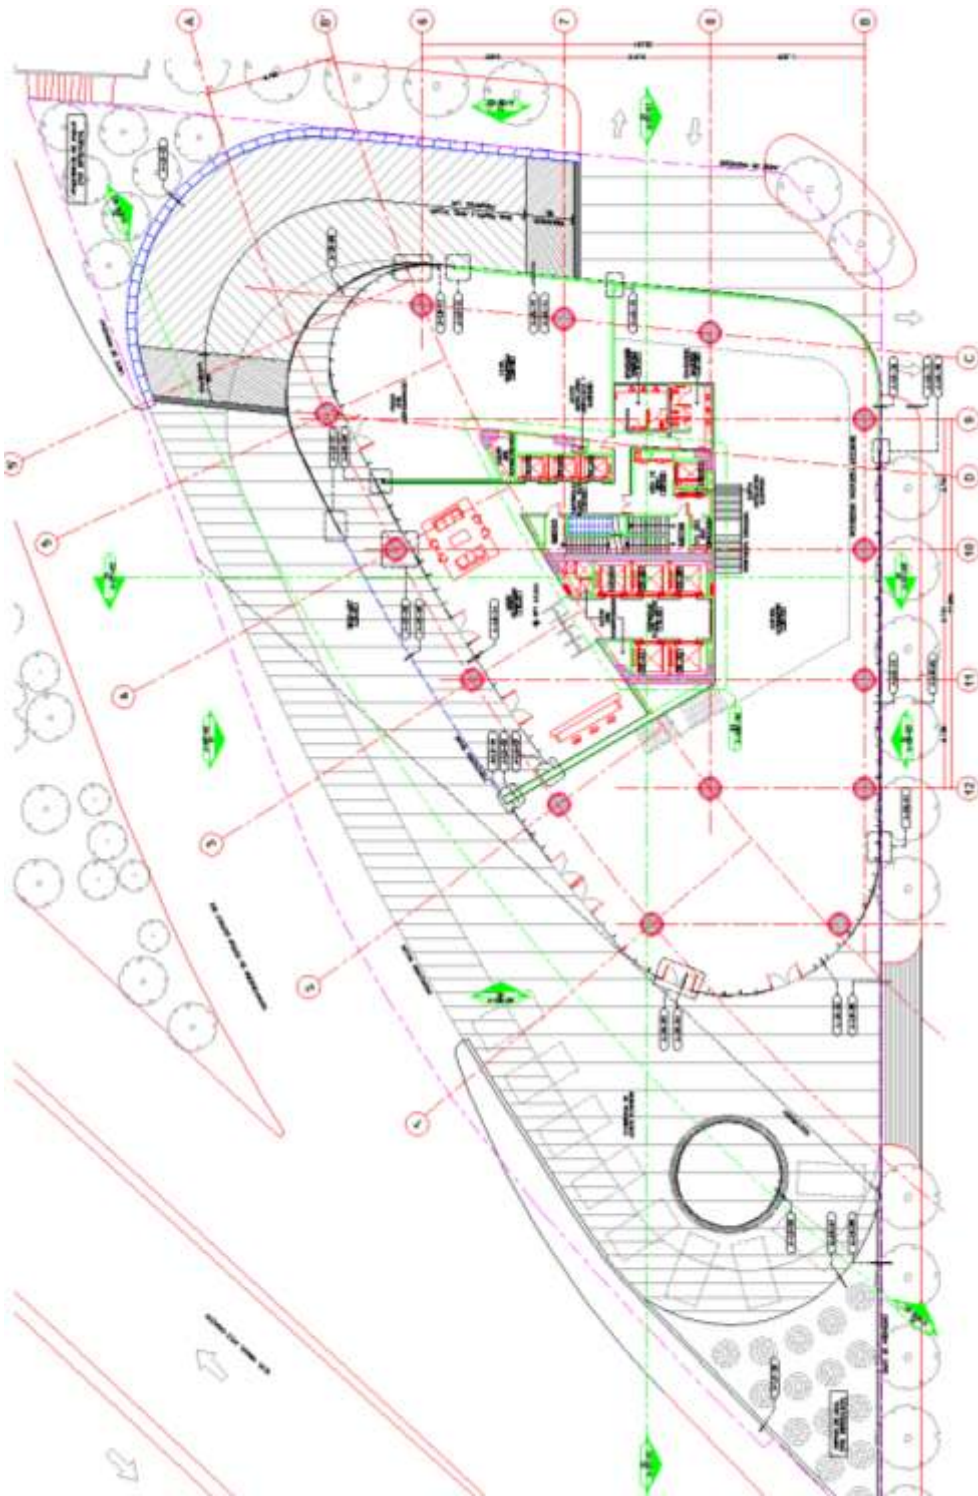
ANTEPROYECTO PLANTA ARQUITECTONICAPLANTA BAJA
